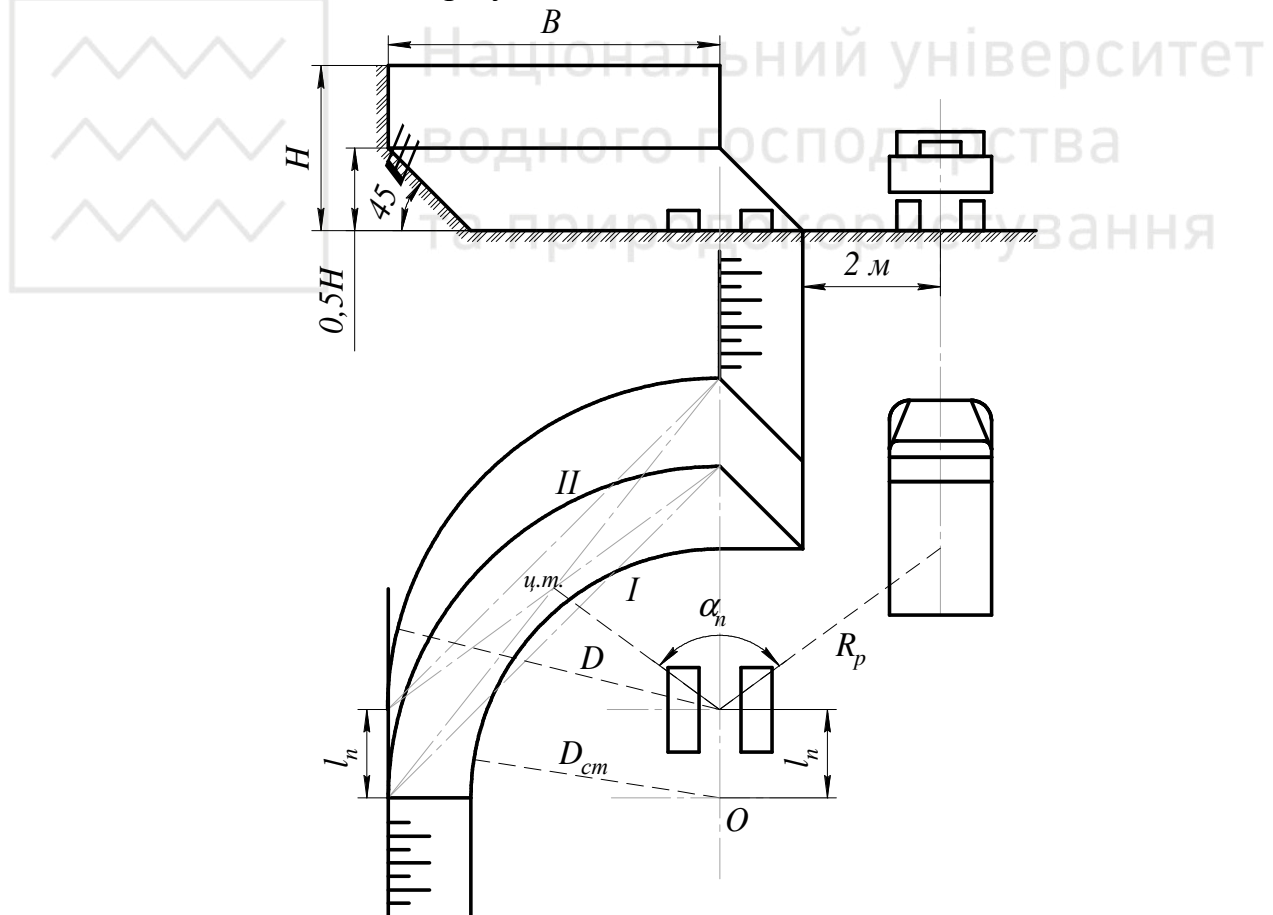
Розрахунковий боковий забій екскаватора з прямою лопатою
